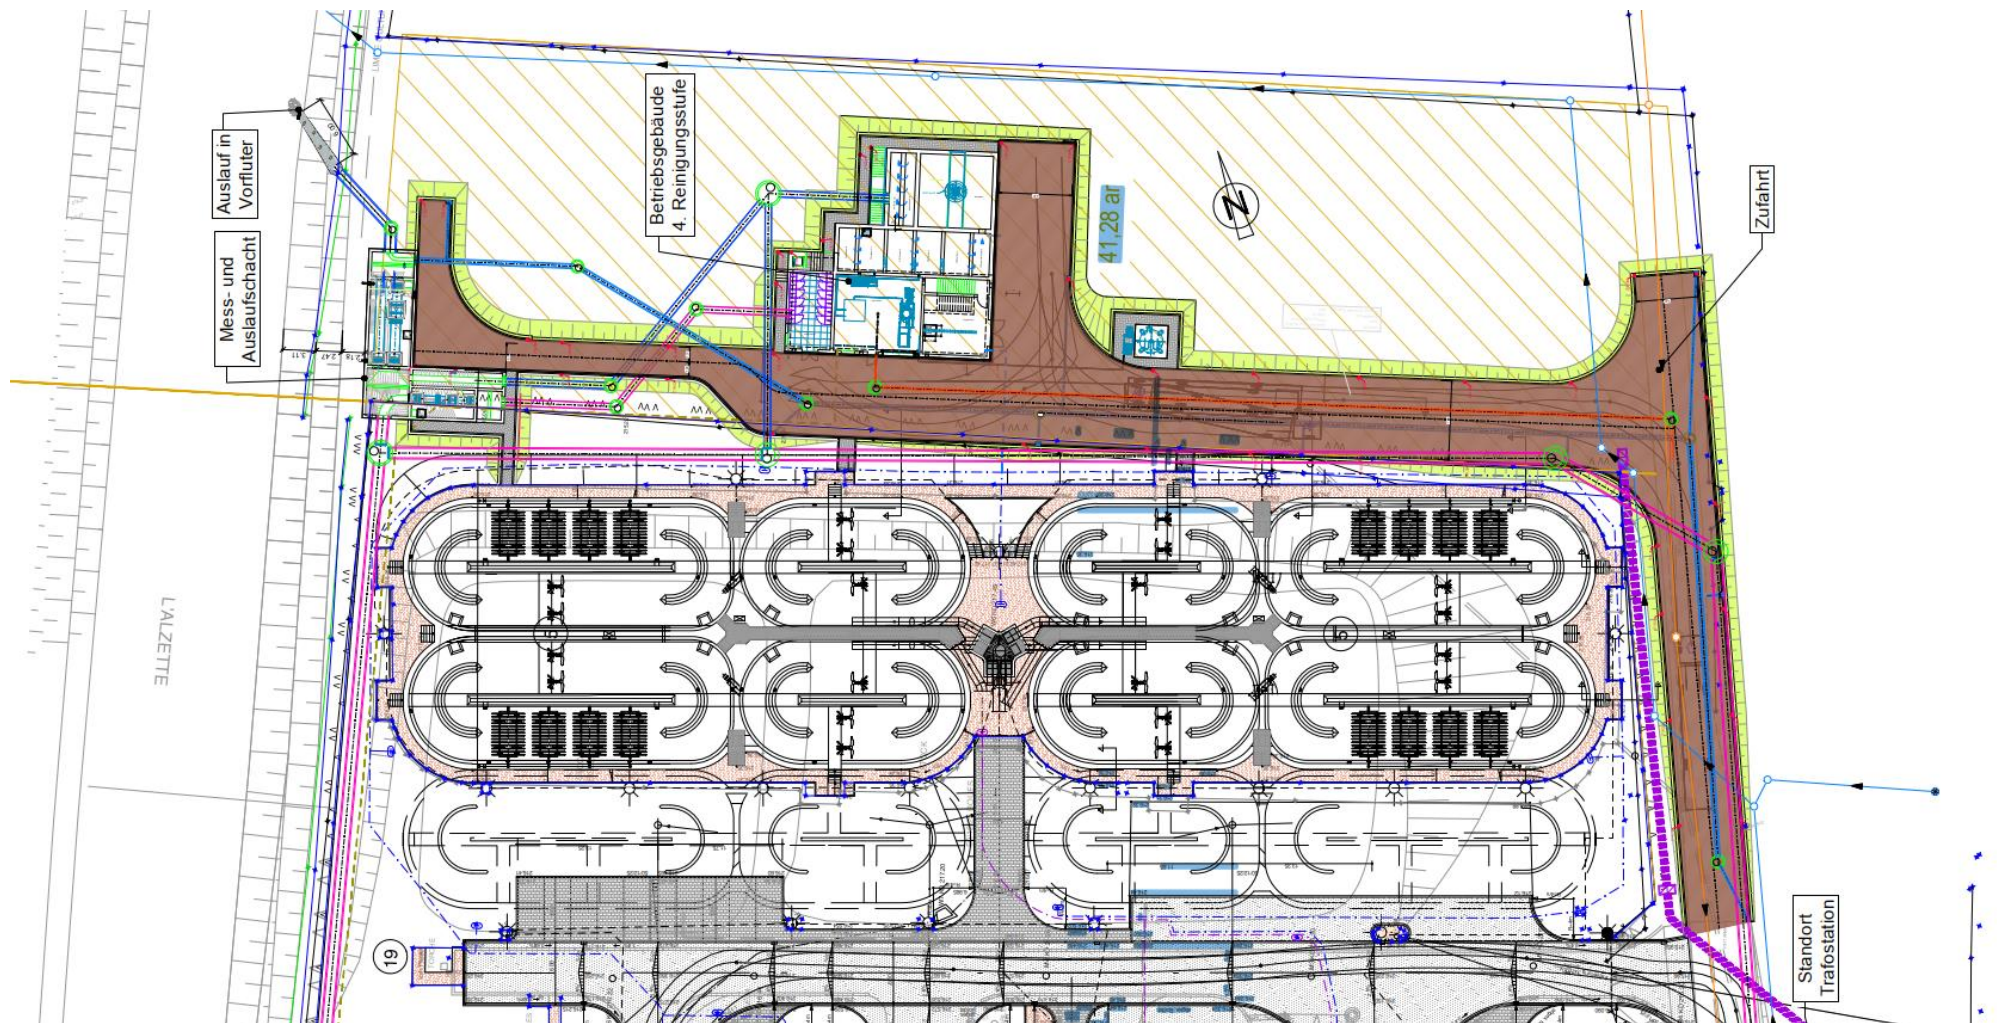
Übersicht der Lageplanung der Kläranlagenerweiterung für die vierte Reinigungsstufe (APD Stand 27.11.2024, Plan-Nr. STP-APD-LP-10, entsprechend Volumenbilanzierung, TR-Engineering, 02/2025). Größere Darstellung in Anhang 04.
